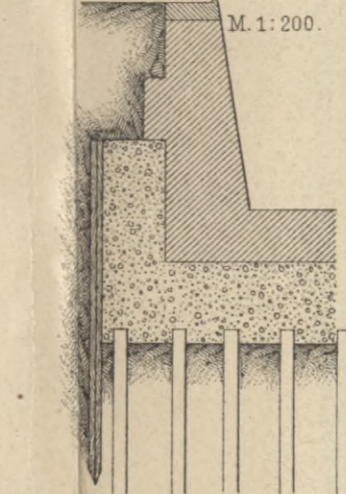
u. 24. Strompfeiler der Elbbrücke bei Harburg. M. 1:200. A cross-sectional diagram of a bridge pier for the Elbe Bridge at Harburg.
